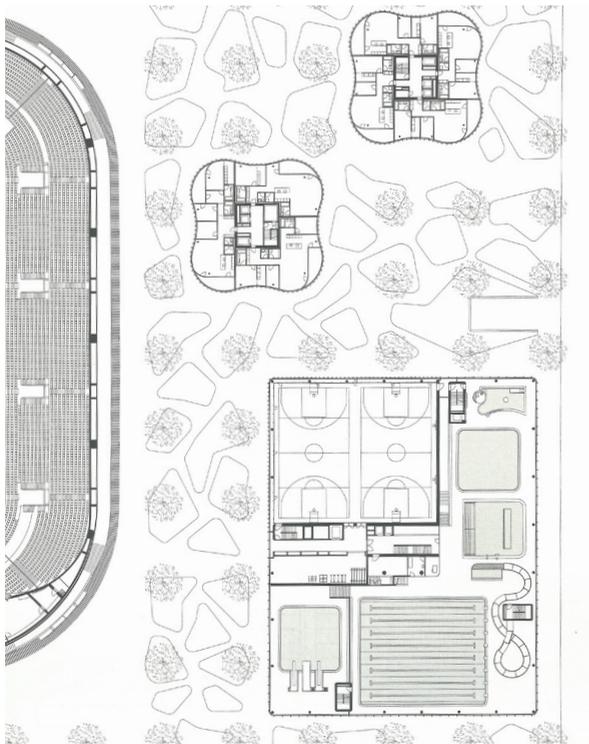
Campus Luzern, Grundriss Sportgebäude und Wohntürme
